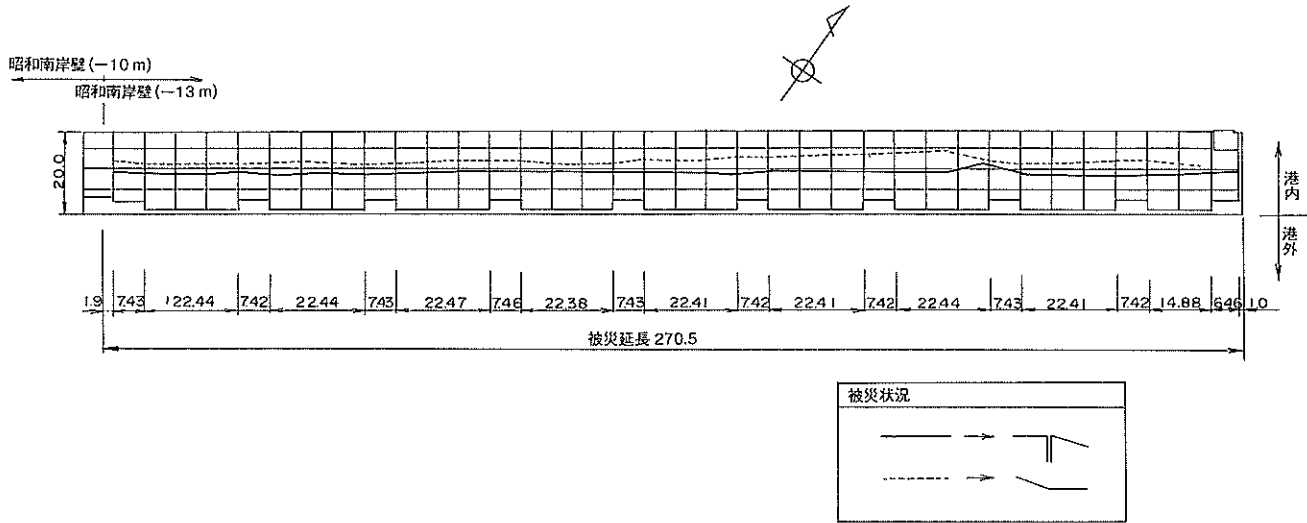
(a) 昭和南1号岸壁被災箇所平面図
